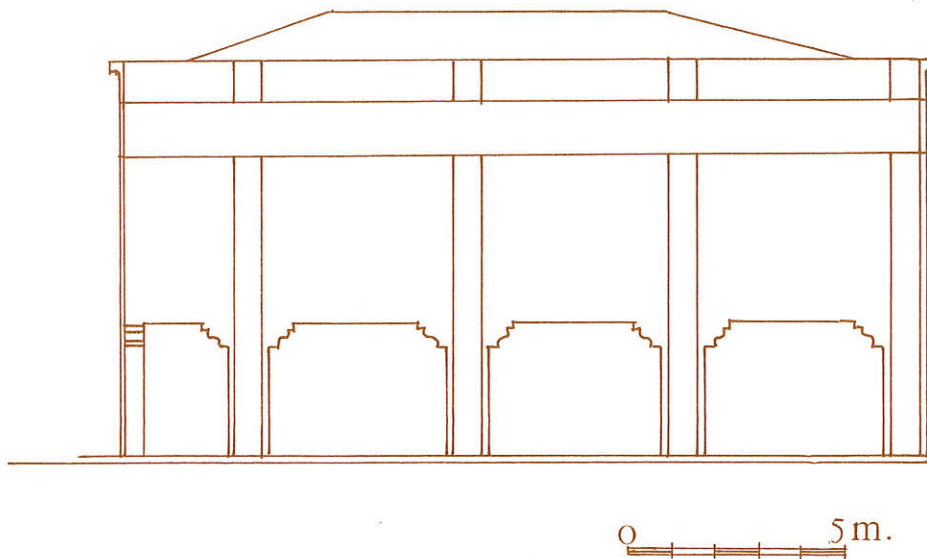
Esquema de la moderna fachada principal del edificio de esquina. Alzado J.
